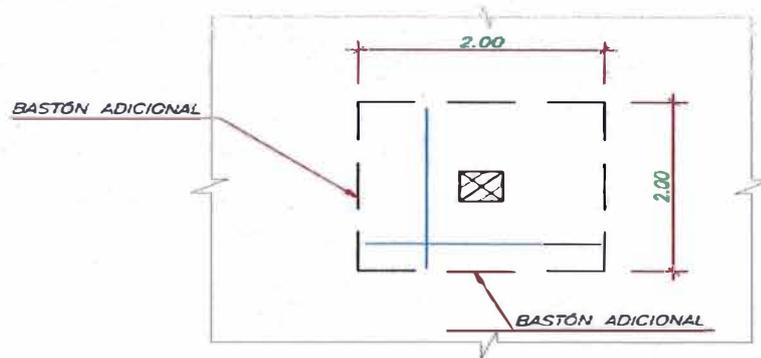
Detalle típico del refuerzo adicional en la cara del muro en contacto con la tierra
